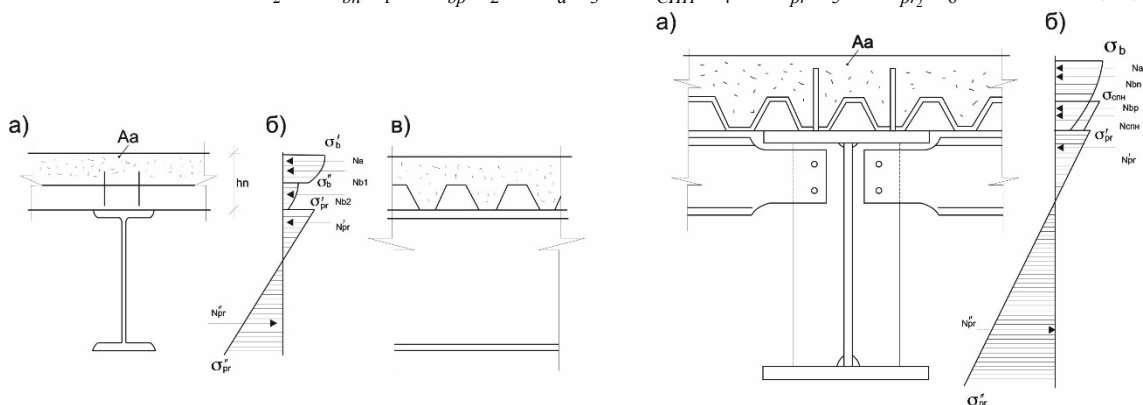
Эпюры напряжений и внутренние усилия для сечения со СПН поперек и вдоль балки: а) сечение поперек балки, б) эпюра напряжений и усилия, в) сечение вдоль балки, г) сечение поперек балки и СПН, д) эпюра напряжений и усилия (иллюстрация авторов)
